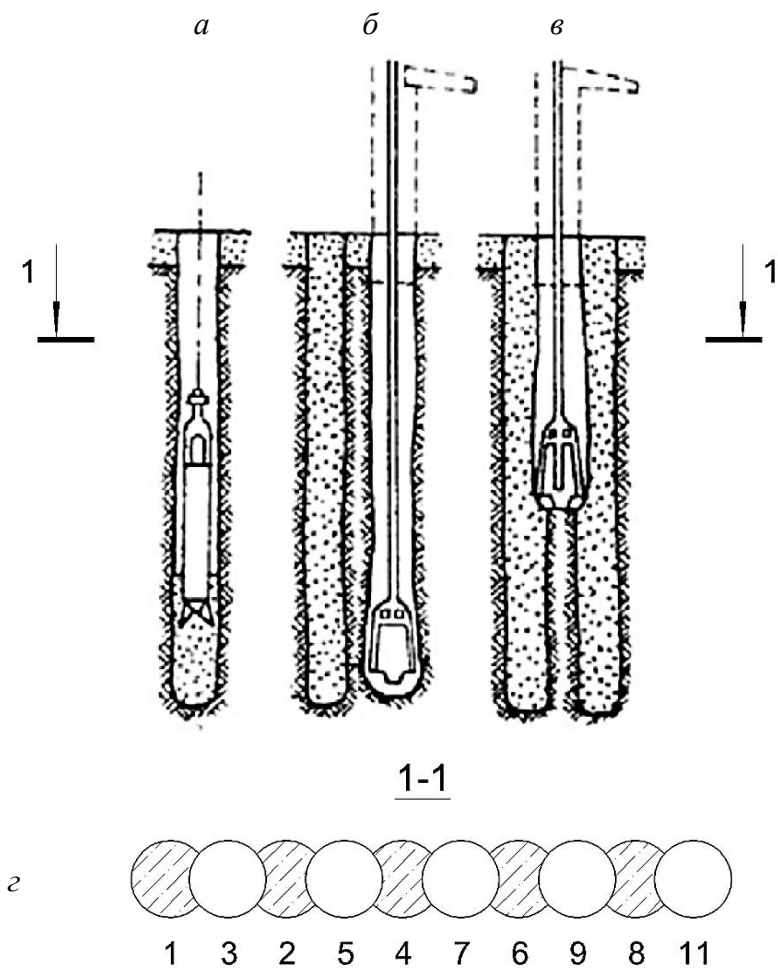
Фундаменты, возводимые способом «стена в грунте»:
